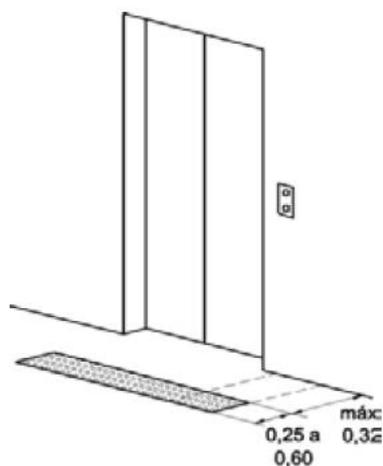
Sinalização tátil de alerta junto à porta de elevador
